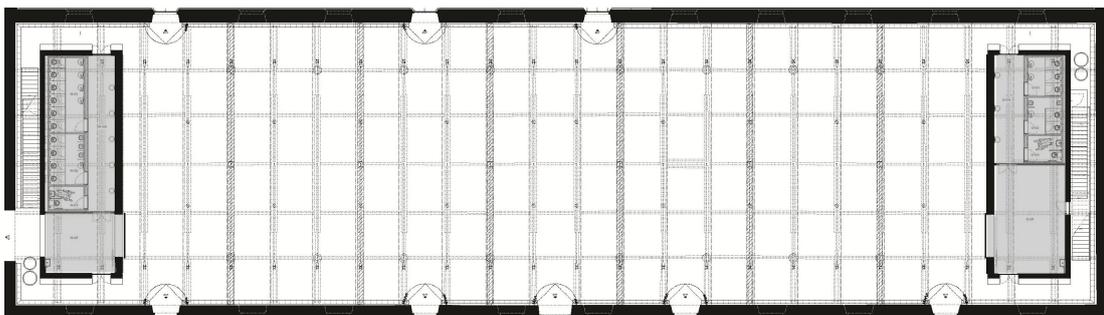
Grundriss Alte Reithalle ohne Bühnen-/Tribünensituation (vgl. Erw. 3.9), ohne Massstab
